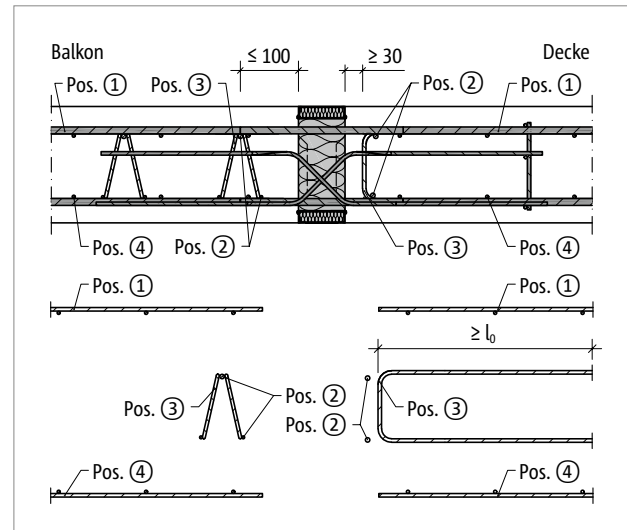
Schöck Isokorb® T Typ DP: Bauseitige Bewehrung mit Gitterträger
